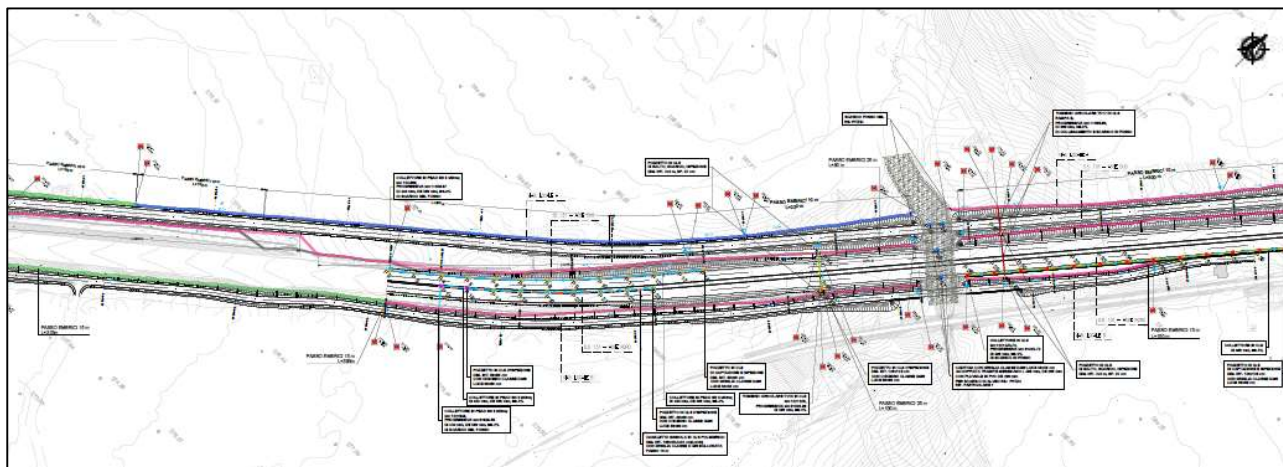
Stralcio planimetrico intervento S20-Risoluzione accessi al km 122+000, inquadramento 2/3
